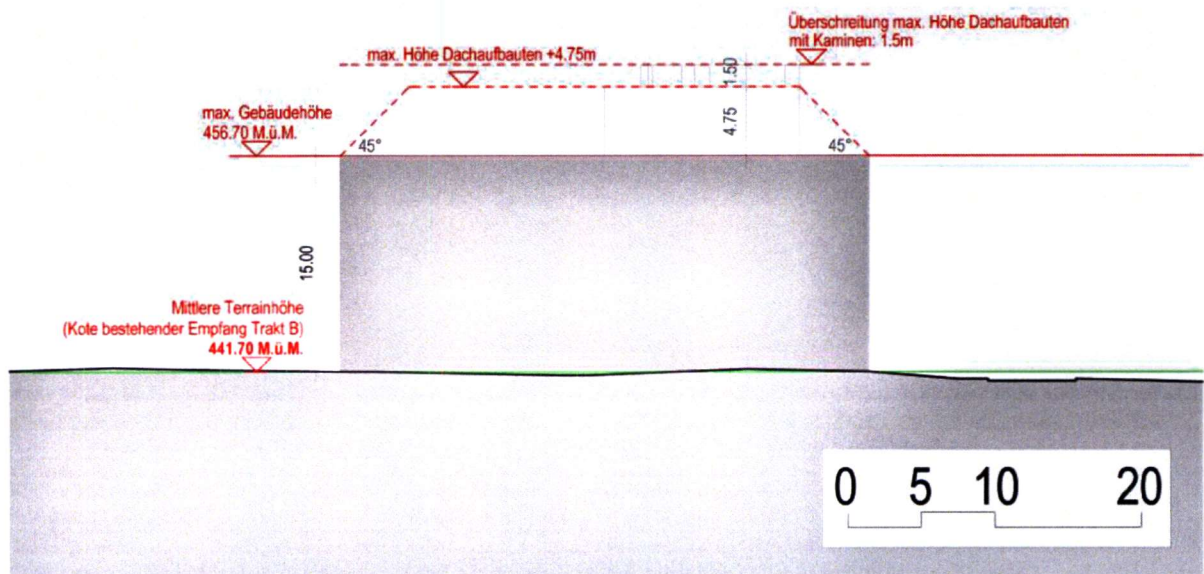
45° Regelung Dachaufbauten, MSt. 1:500 (Quelle: BGP Architekten)
